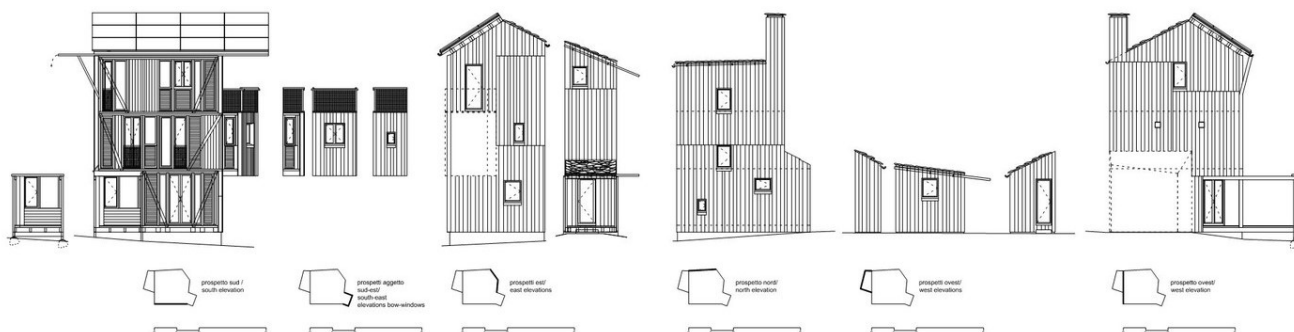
Solar house jižní fasáda (Archdaily, 2011)
